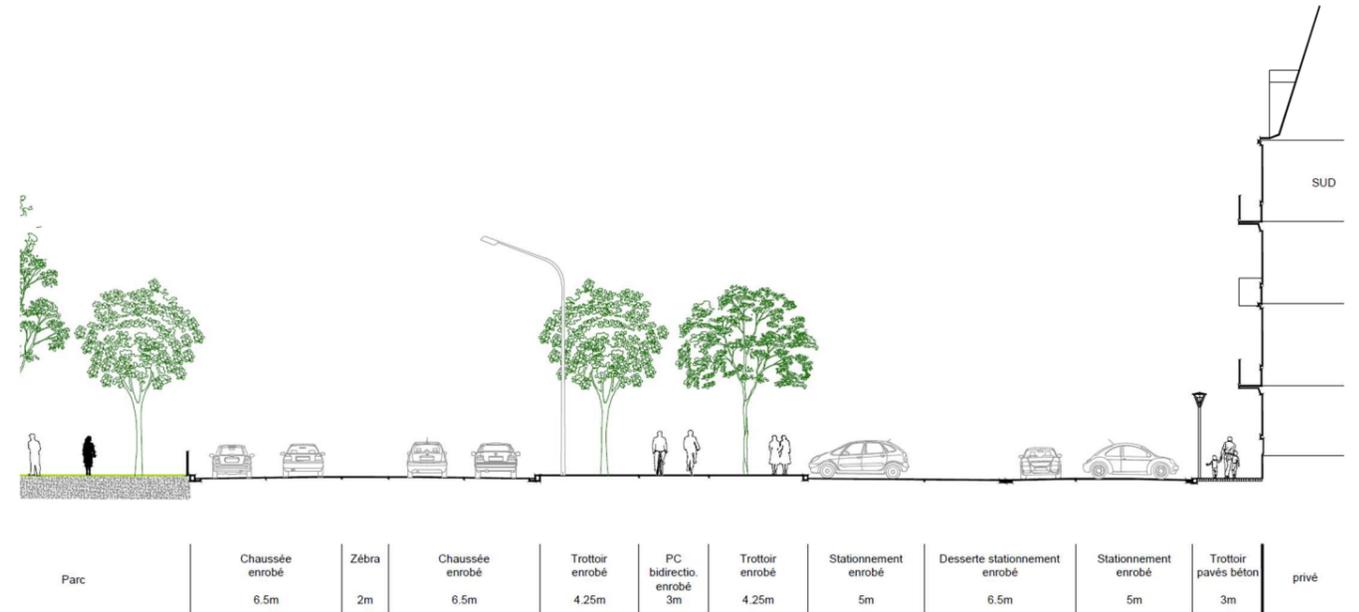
Plan de la place de Haguenau (source : AVP GETAS, 2023)
